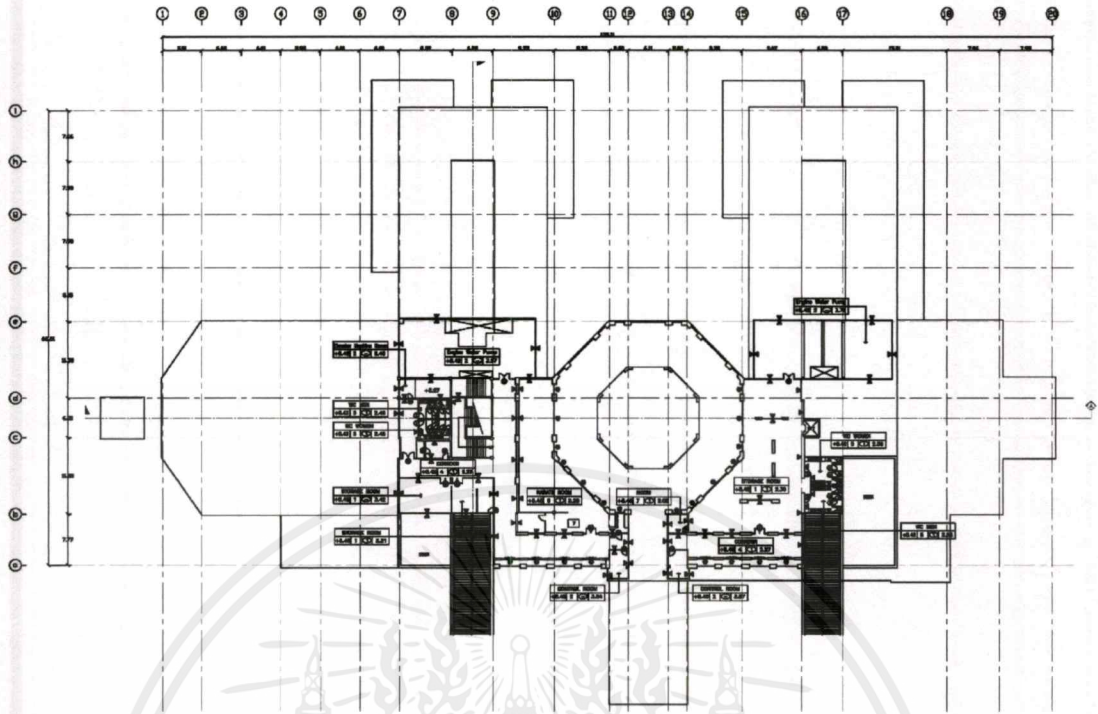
ผังอาคาร A ชั้น GROUND FLOOR
